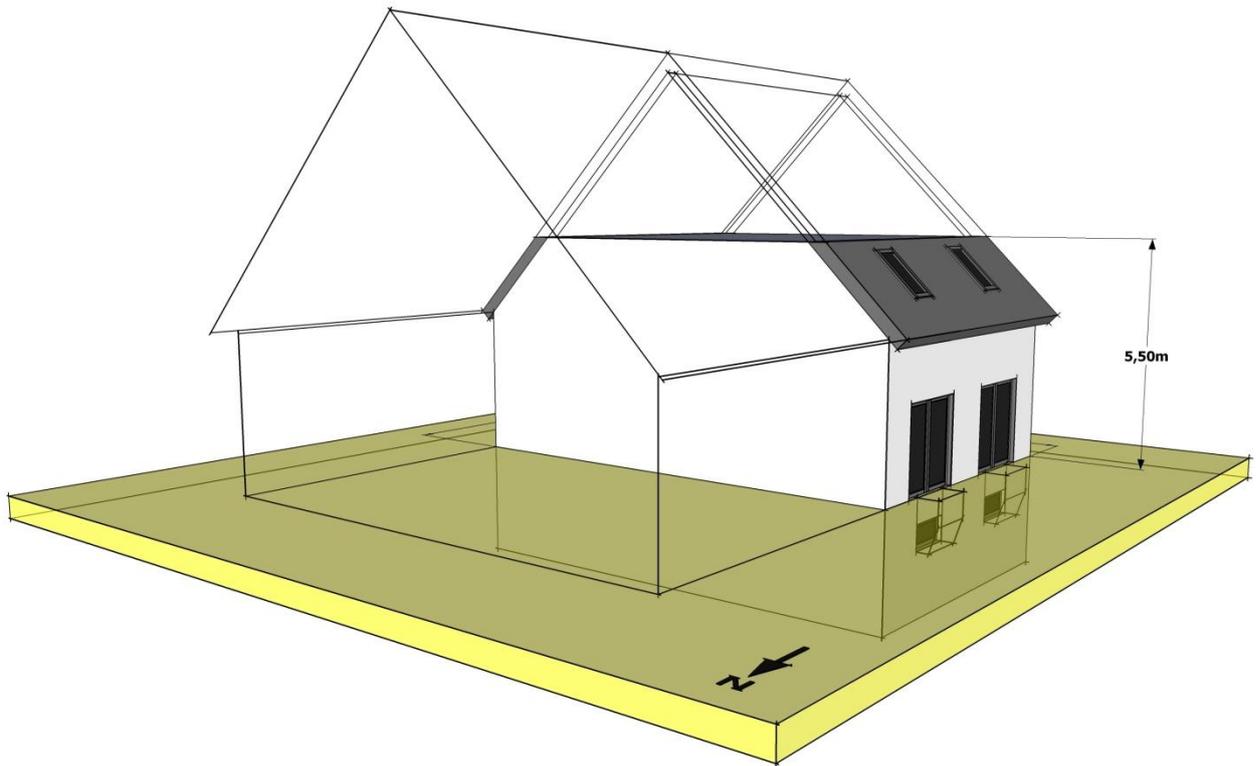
Doppelhaushälfte Süd mit Keller- Ansicht Nord-West
